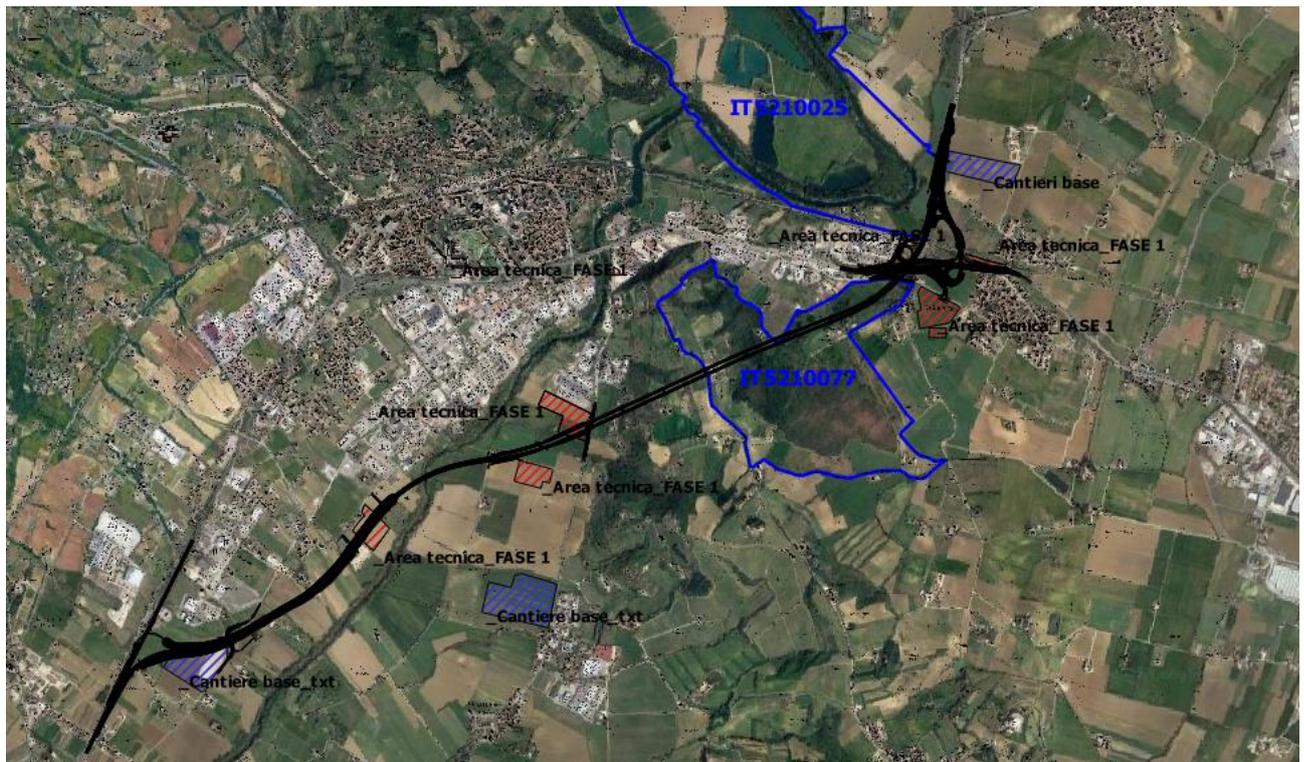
Localizzazione del tracciato in progetto rispetto alle aree di cantiere
